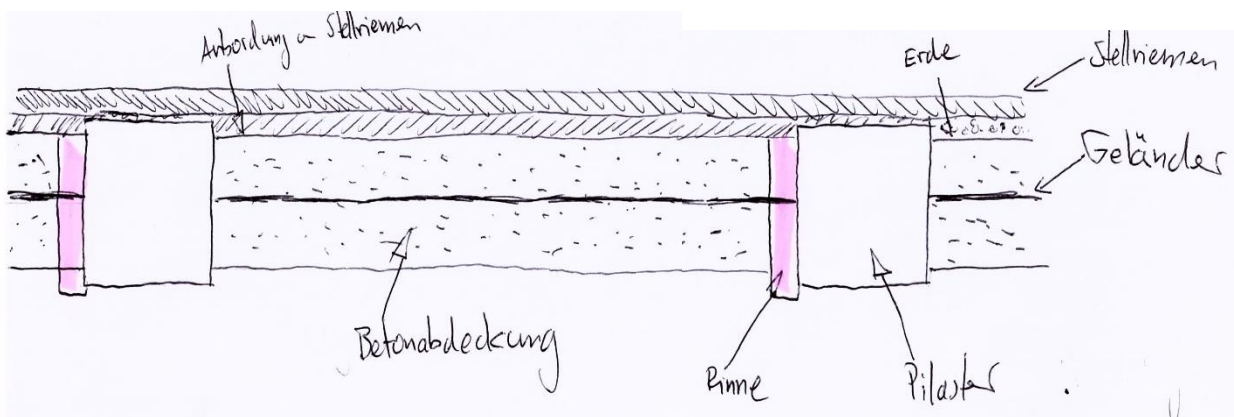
Grundriss des Konzepts der Mauerkrone.
